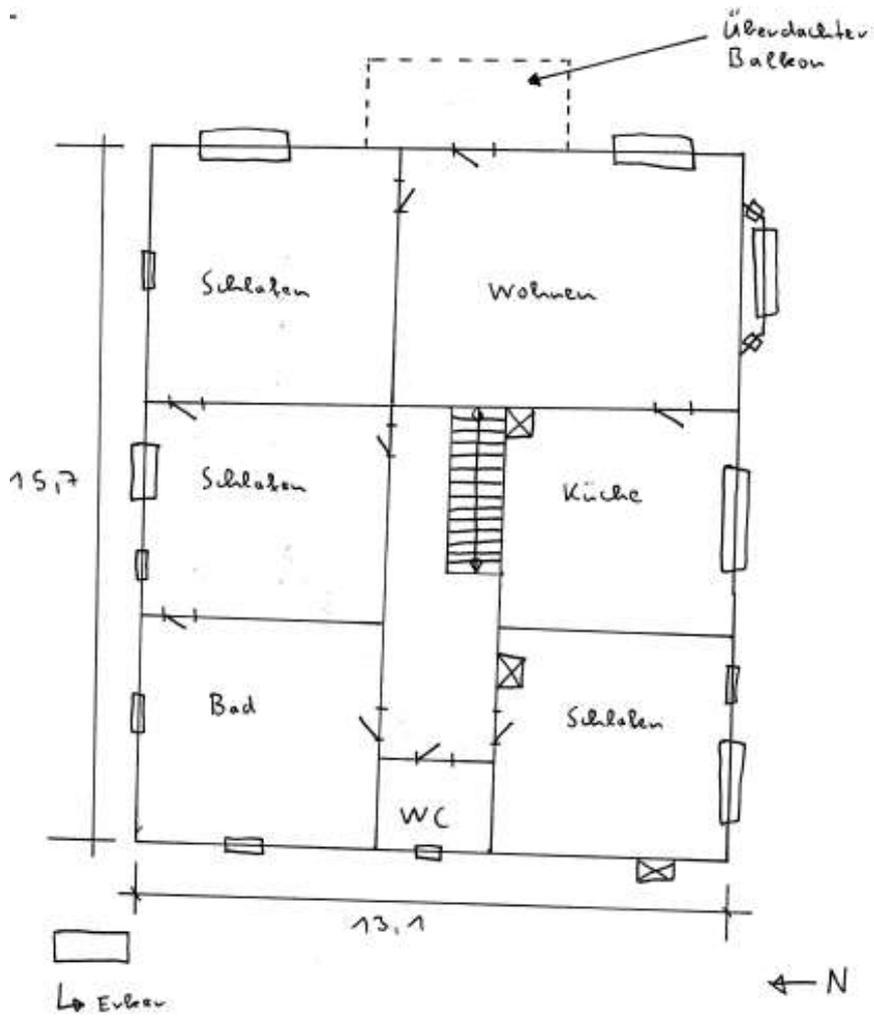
Grundriss Jagdhaus Johnsbach OG
